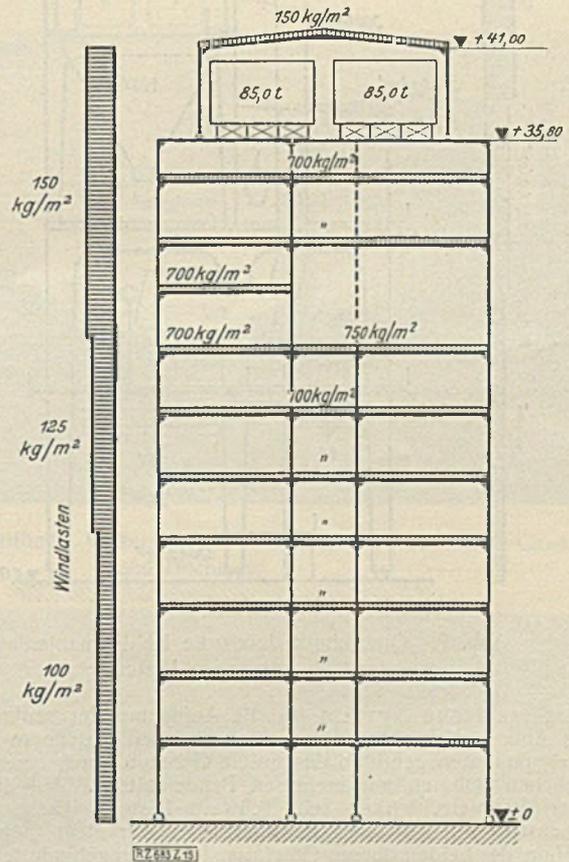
Querschnitt durch das Verwaltungsgebäude mit Deckenlasten.
